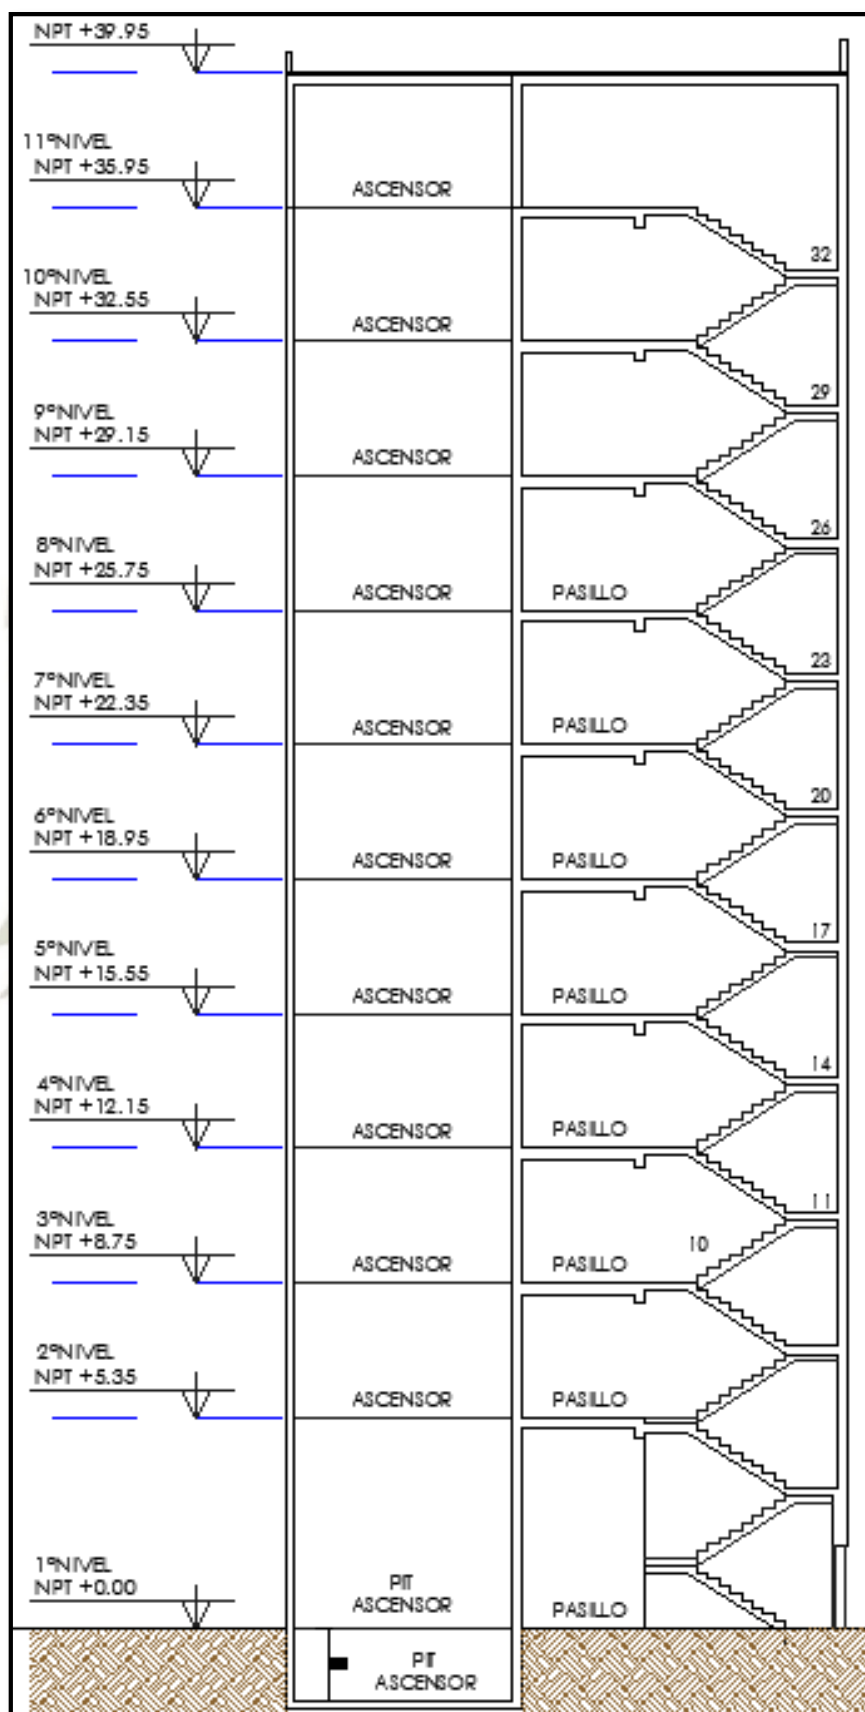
Sección transversal 2-2 (Fuente: Elaboración propia)
